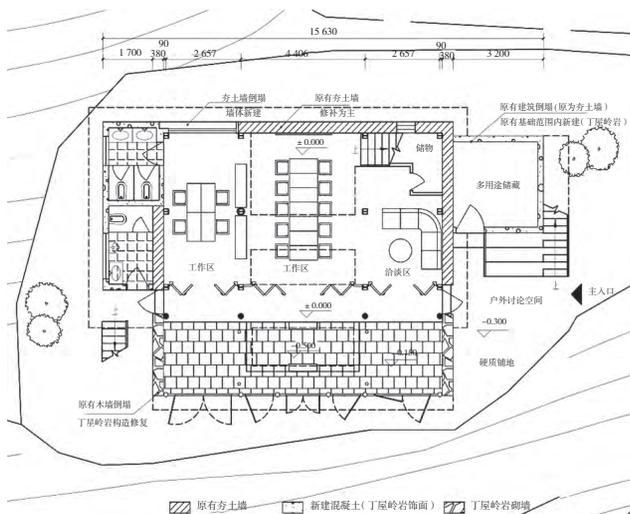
工作室一层平面(尺寸线单位:mm,标高单位:m)
